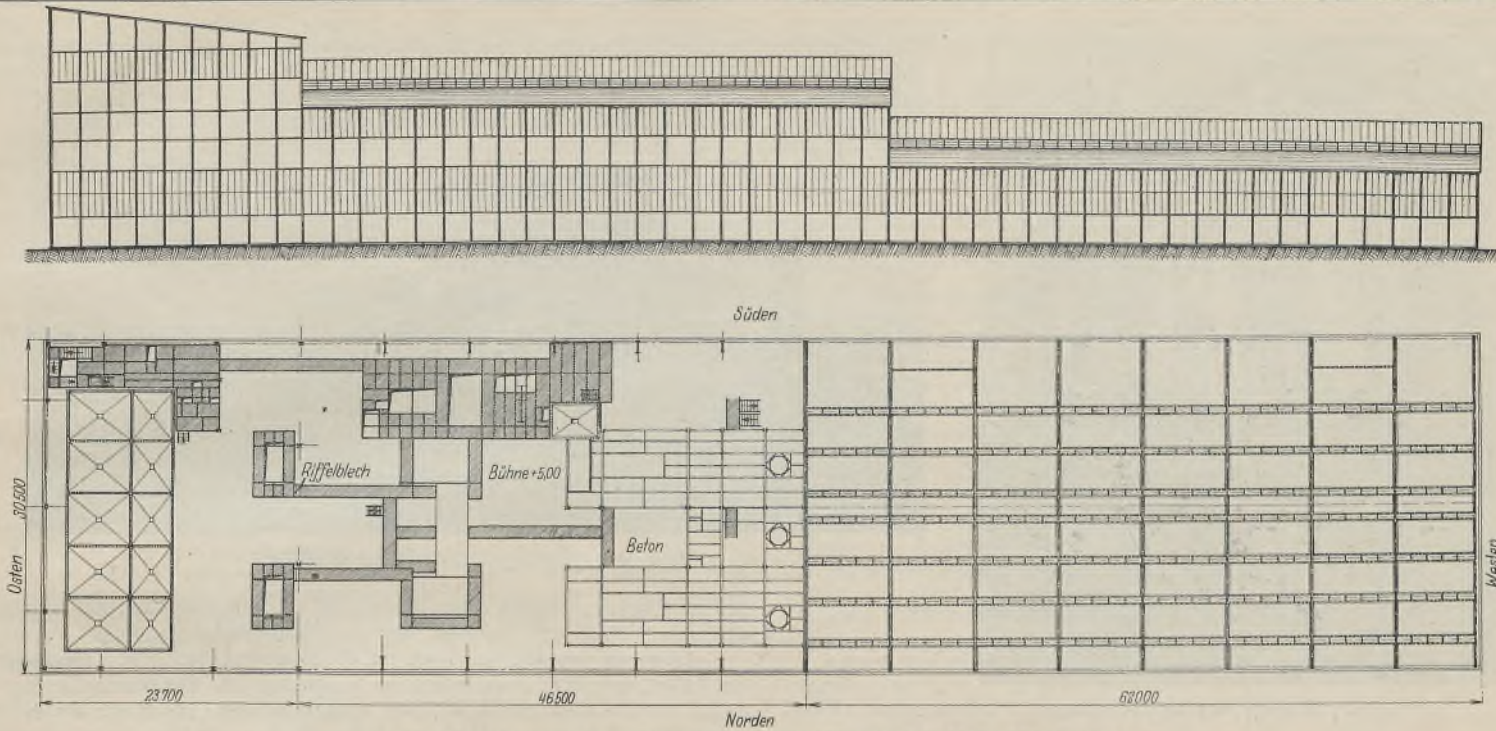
Sinterei, Schmelzanlage und Gießerei; Grundriß und Ansicht.
